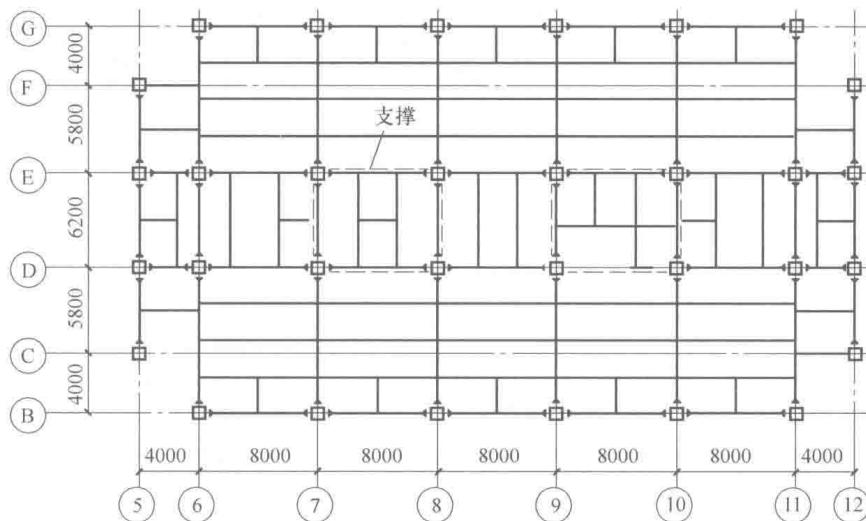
北京长富宫中心饭店钢框架-支撑结构标准层平面布置图
